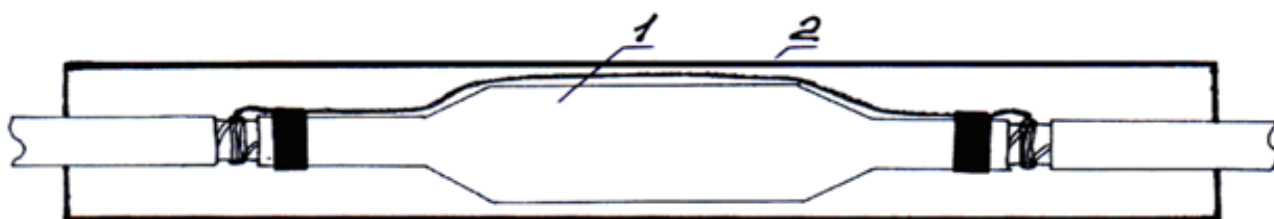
Усадка наружной трубки ТУТ: 1 – усаженная внутренняя ТУТ; 2 – наружная трубка ТУТ перед усадкой.
